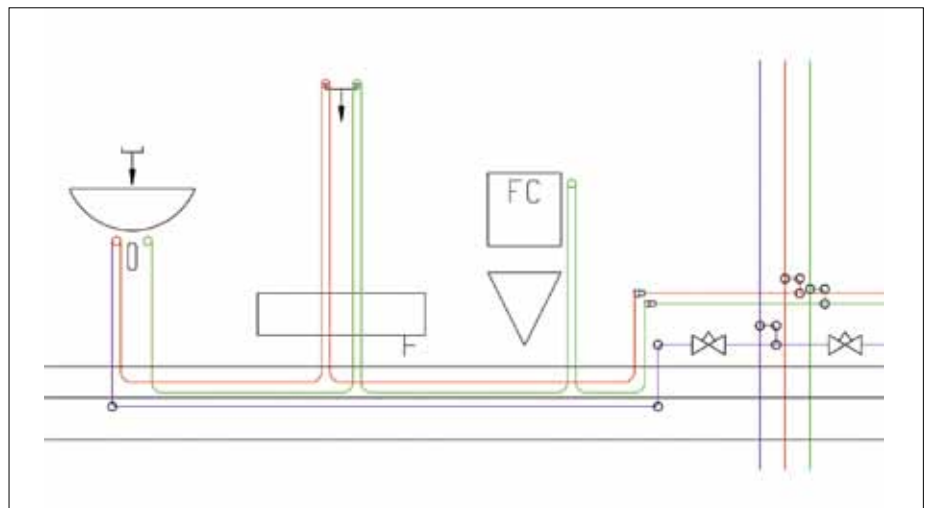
Installation auf Stockwerksebene inklusive eingeschleifter Zirkulation.
